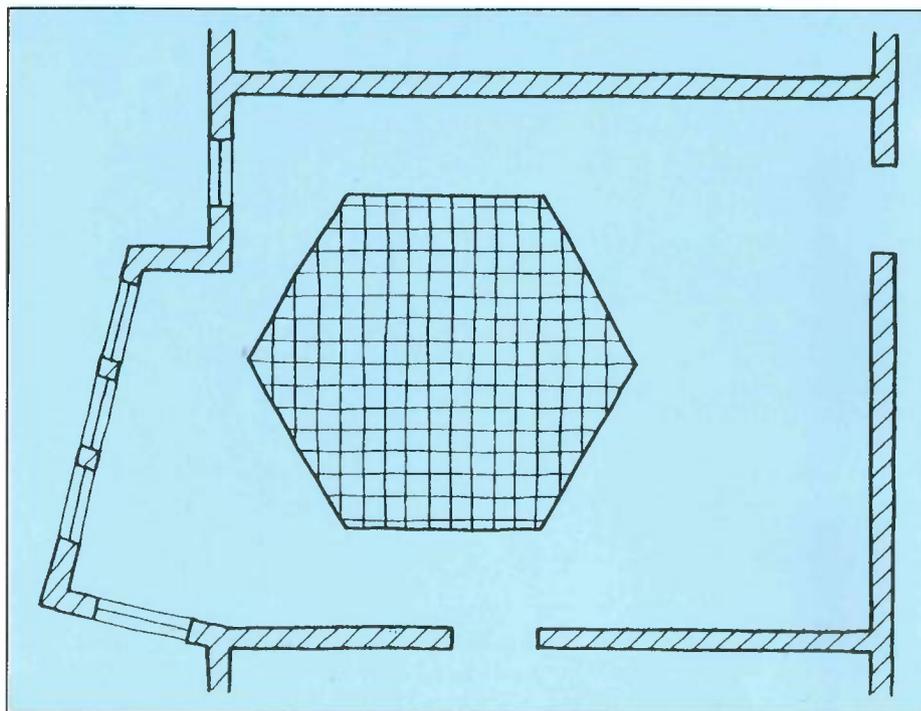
Grundriss eines Gruppenraumes mit ursprünglicher Deckenbekleidung
